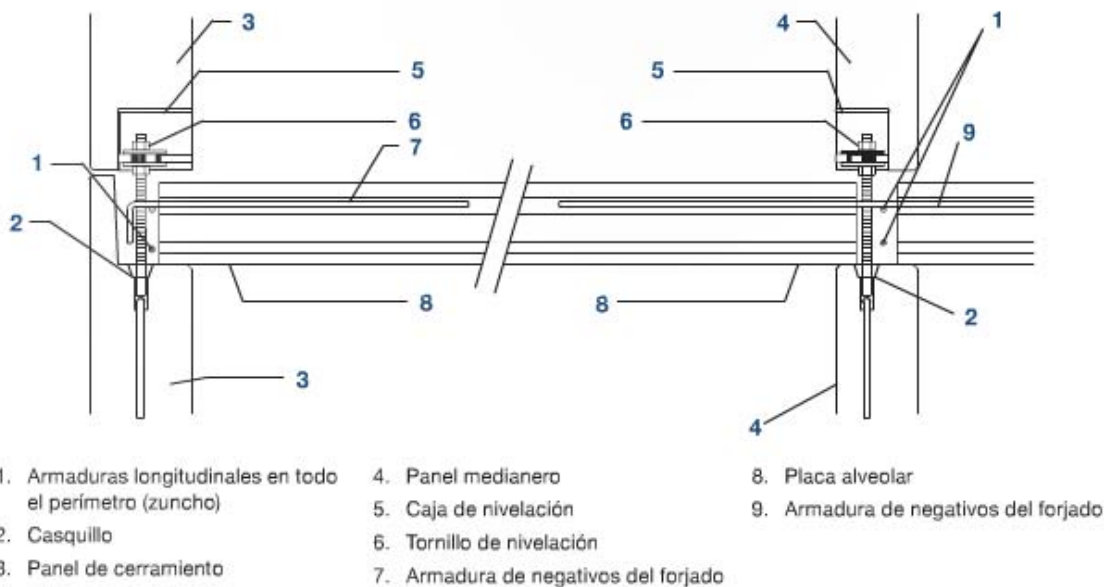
Detalle del encuentro del forjado con los paneles verticales (dimensionado del armado no genérico).
